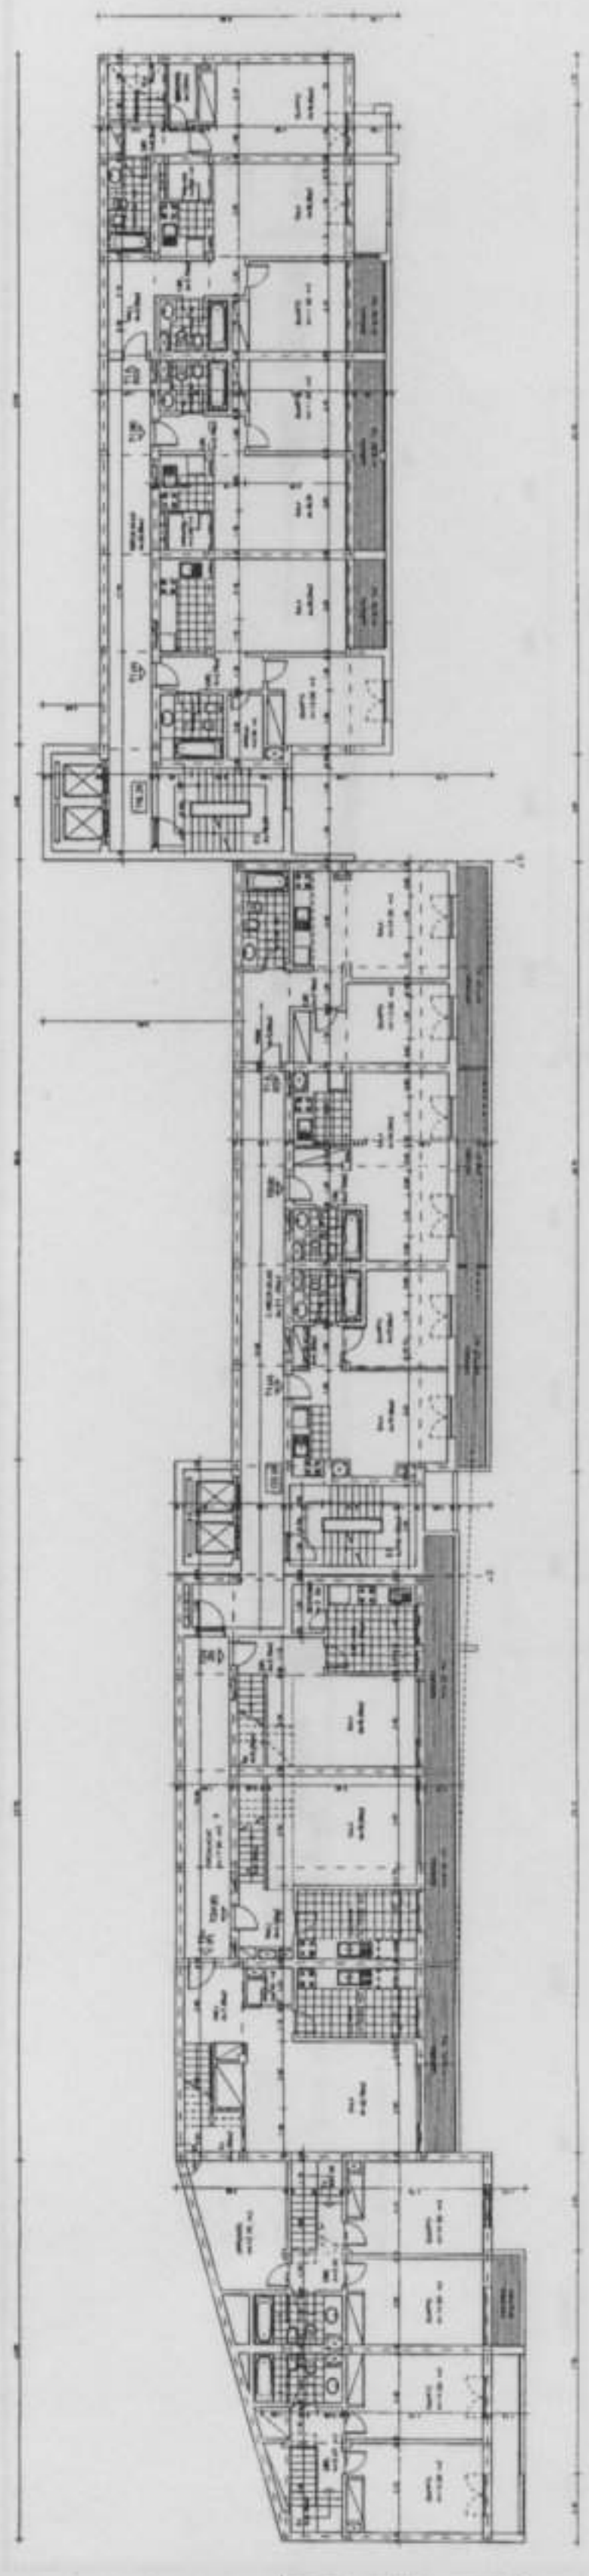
Condomínio de S. Martinho- Planta de um dos pisos,
